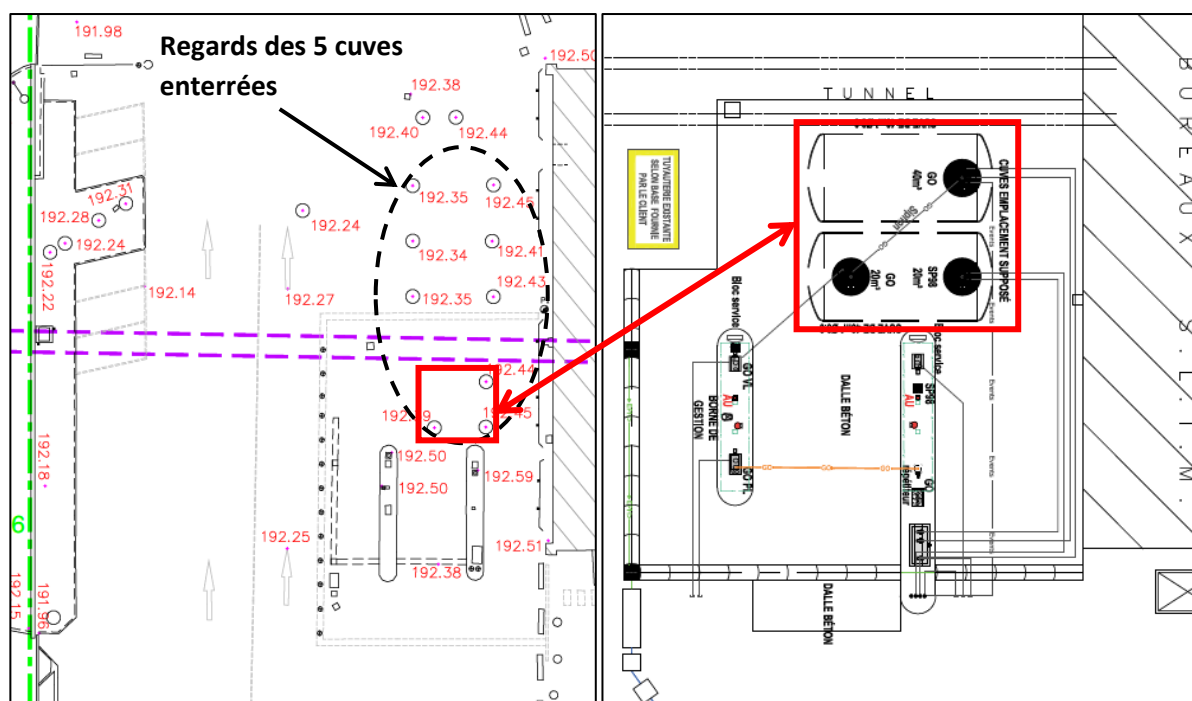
Plan topographique de la station-service (à gauche) et plan des infrastructures de la station-service (à droite)
